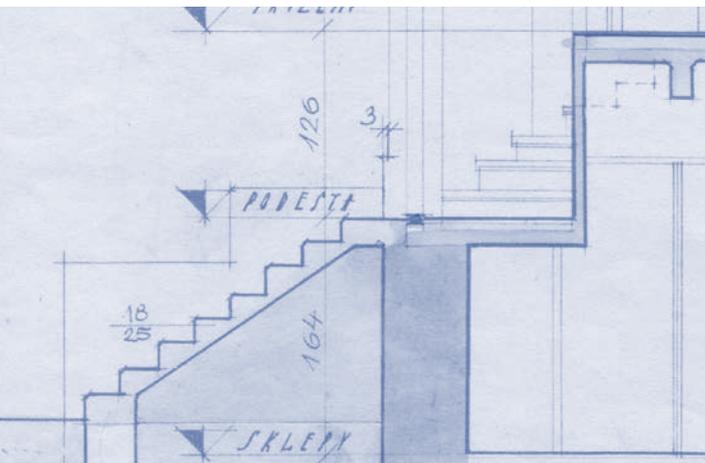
Entwurf Haupteingang Haus Müllers, 1927, Bauplan, Privatarchiv Villa Müller
